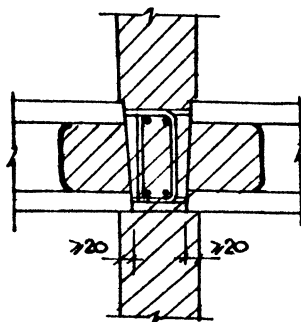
Узлы сопряжения монолитных стен с неразрезными перекрытиями из сборных плит:
